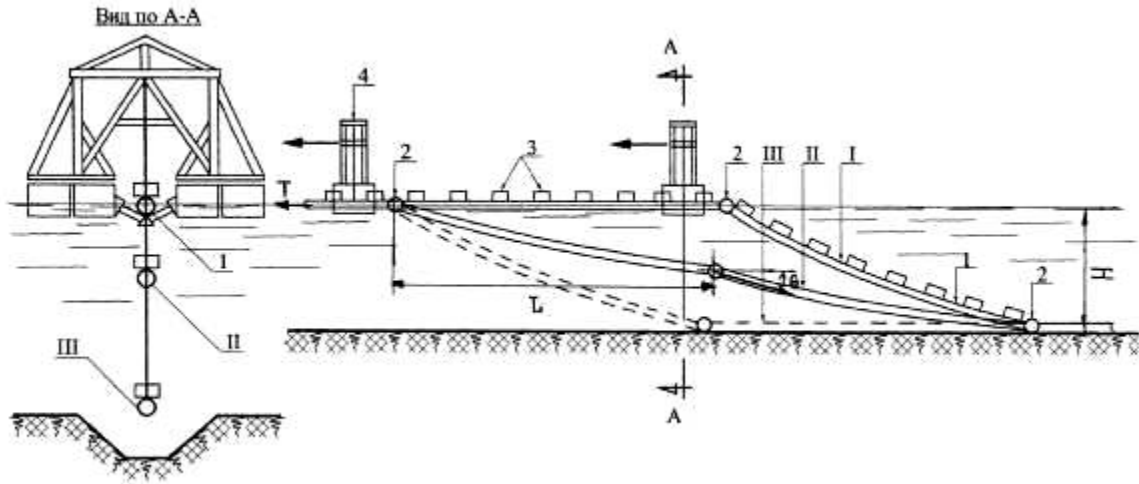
Схема укладки подводного трубопровода способом опускания отдельных шарнирно-соединенных секций с плавучих опорных точек:
